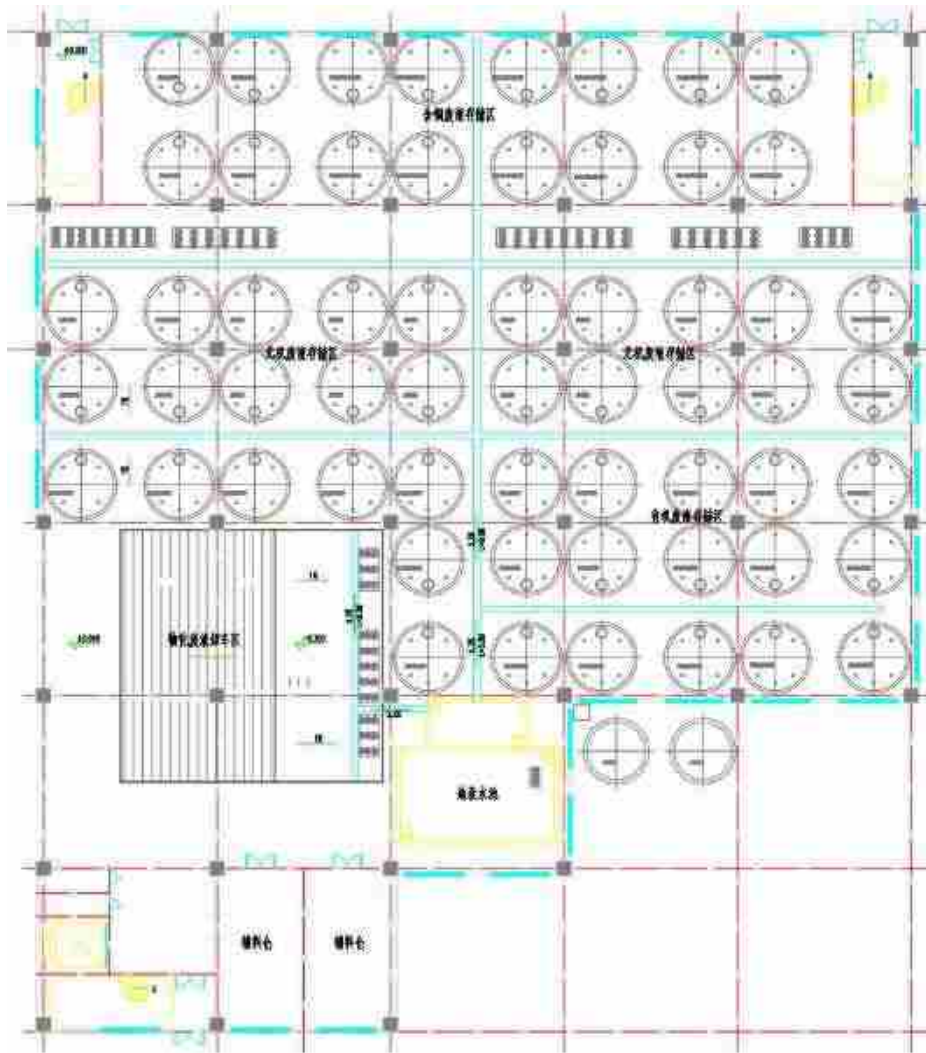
(1) 本次改扩建后 8#\*厂房 1 层平面布置图
